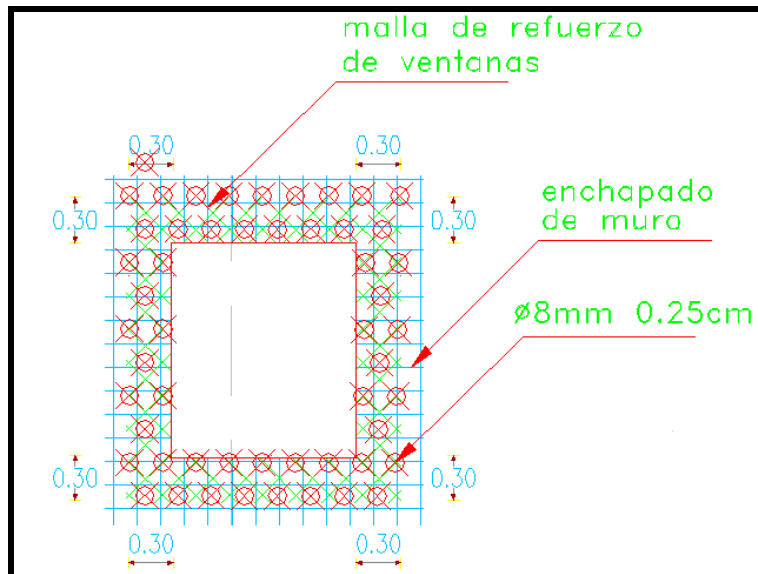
Refuerzo en aberturas de muros de adobe
